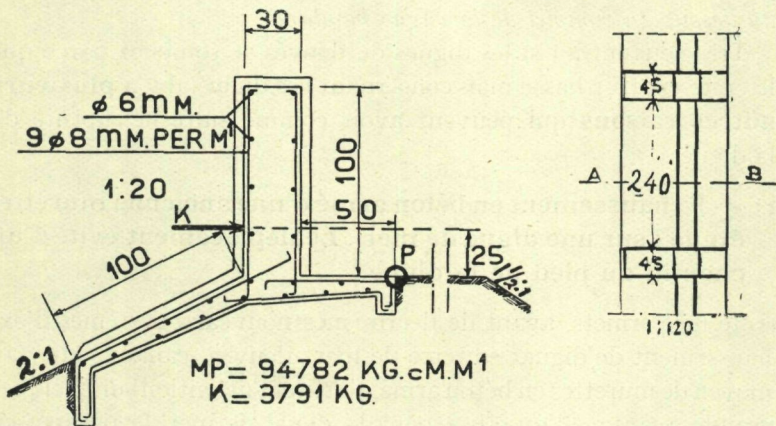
Coupe transversale et horizontale de la murette en béton armé sur une digue de mer.
